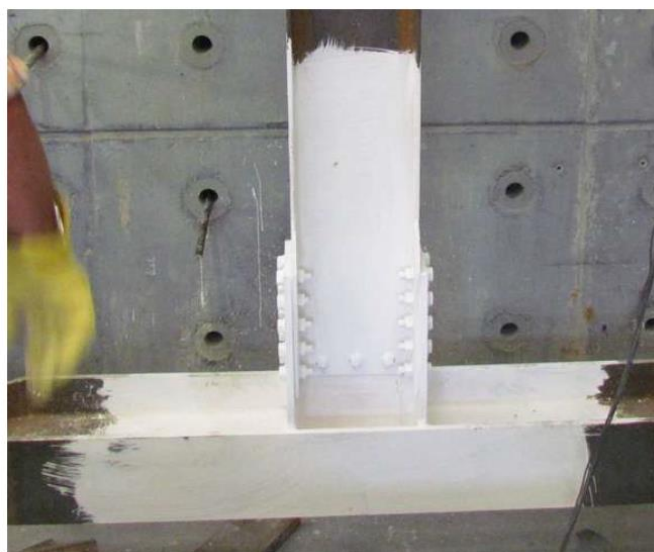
Espécimen de prueba pernado para calificación de conexión en perfiles en I, con la viga pernada al eje débil de la columna. Fuente: (García, 2015)
